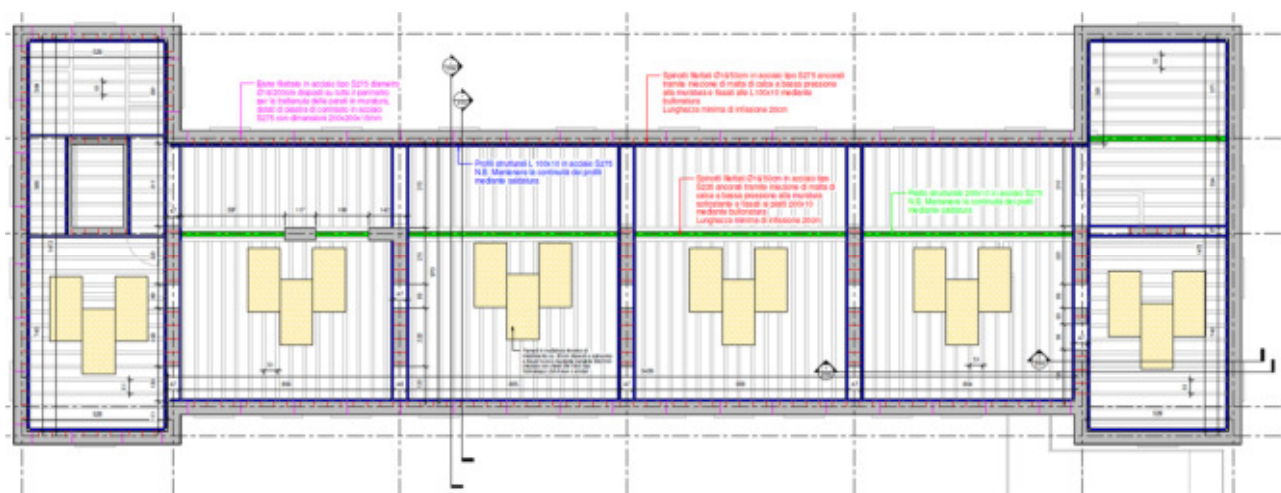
Pianta del sottotetto con indicazione dell'intervento
